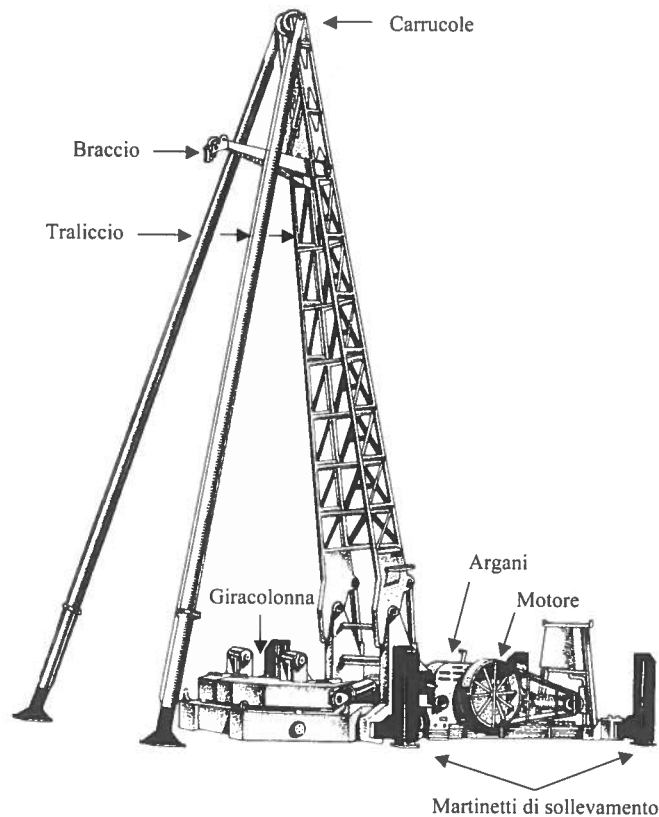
Impianto di perforazione a secco del tipo a terra con giracolonna.
